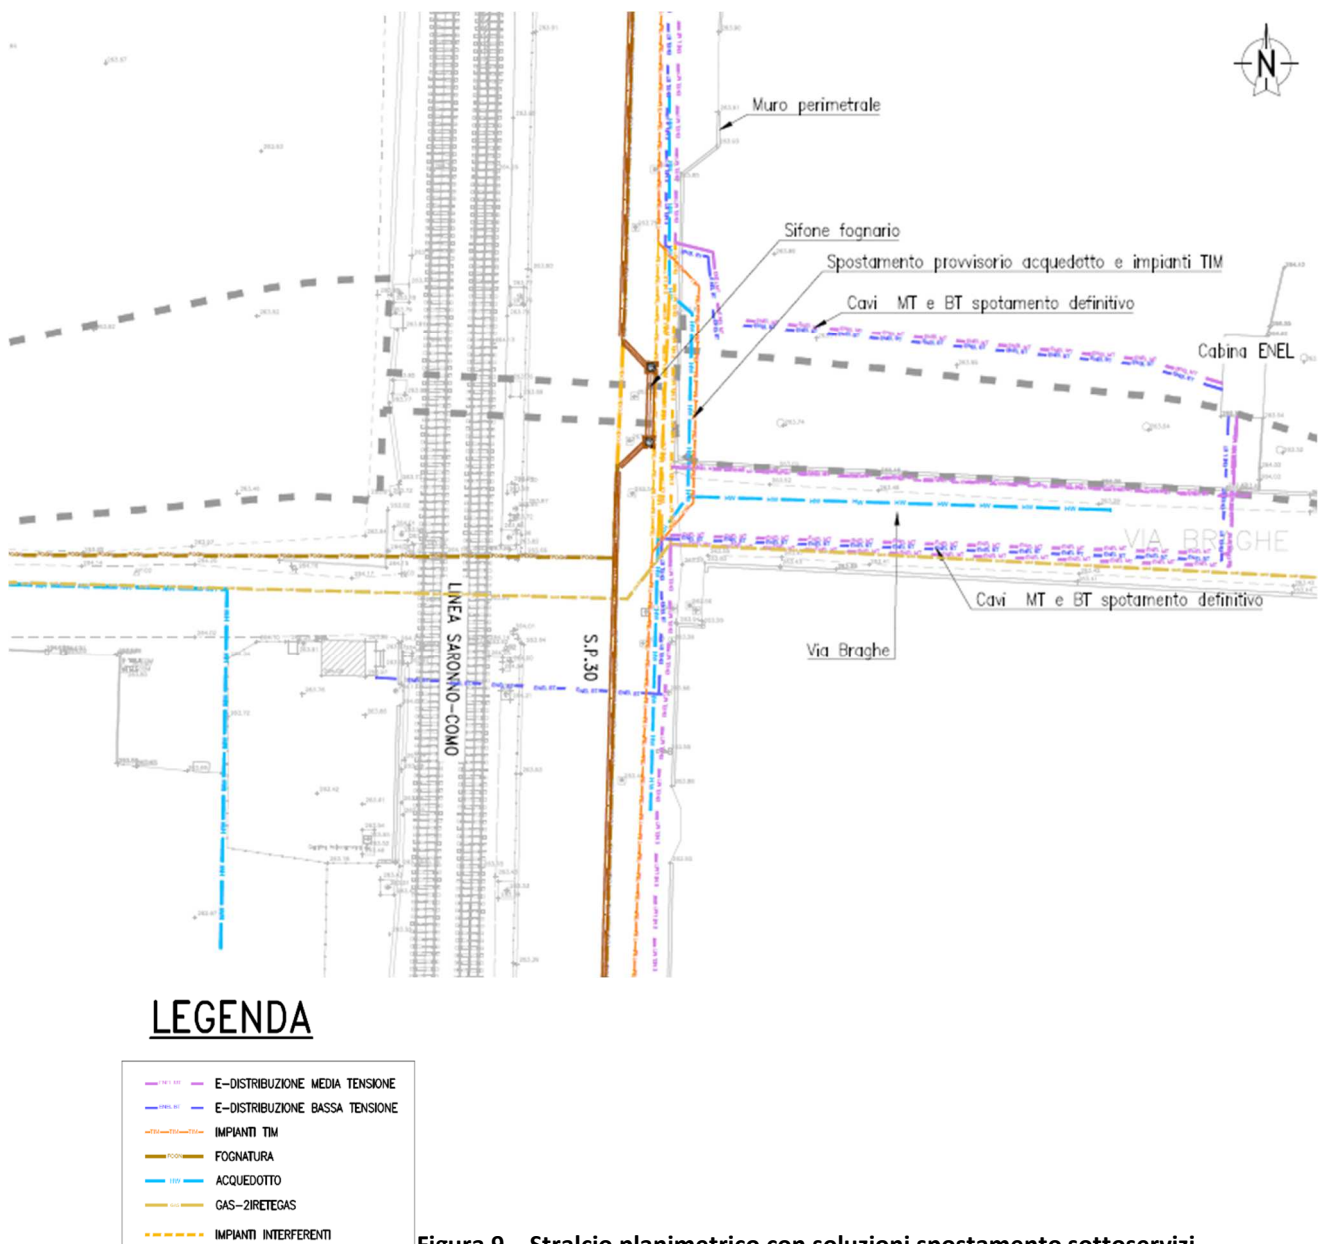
Stralcio planimetrico con soluzioni spostamento sottoservizi
